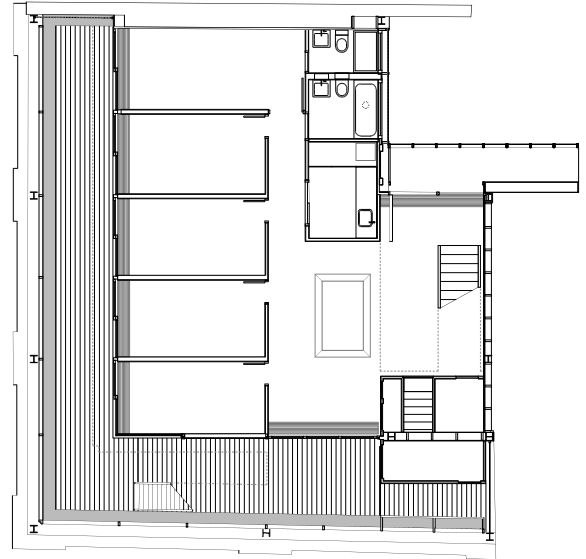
Grundriss 5.OG © Tonkin Liu
